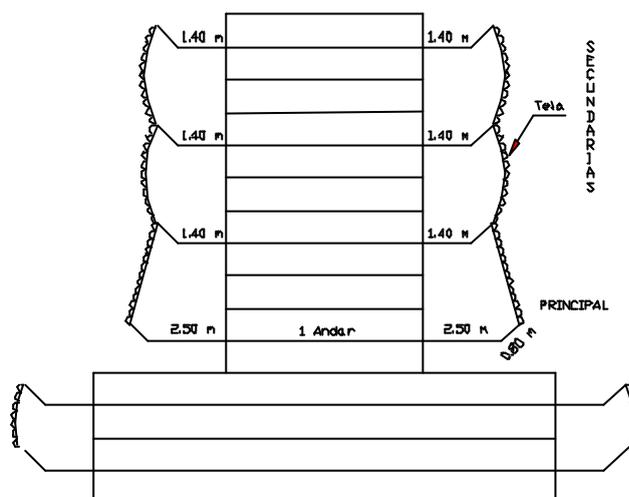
Plataformas de proteção em construções com pavimentos recuados
